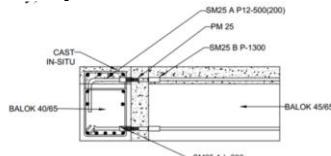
Konsol Pendek Sambungan Balok dan Kolom
